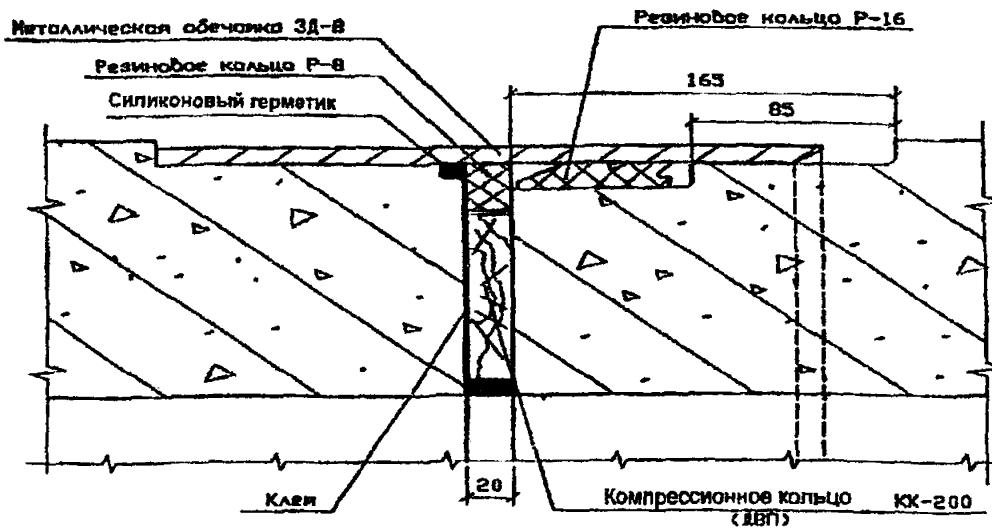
Схема стыкового соединения железобетонных труб ТСМО 100.300-1...ТСМО 200.300-3 с полиэтиленовой облицовкой
